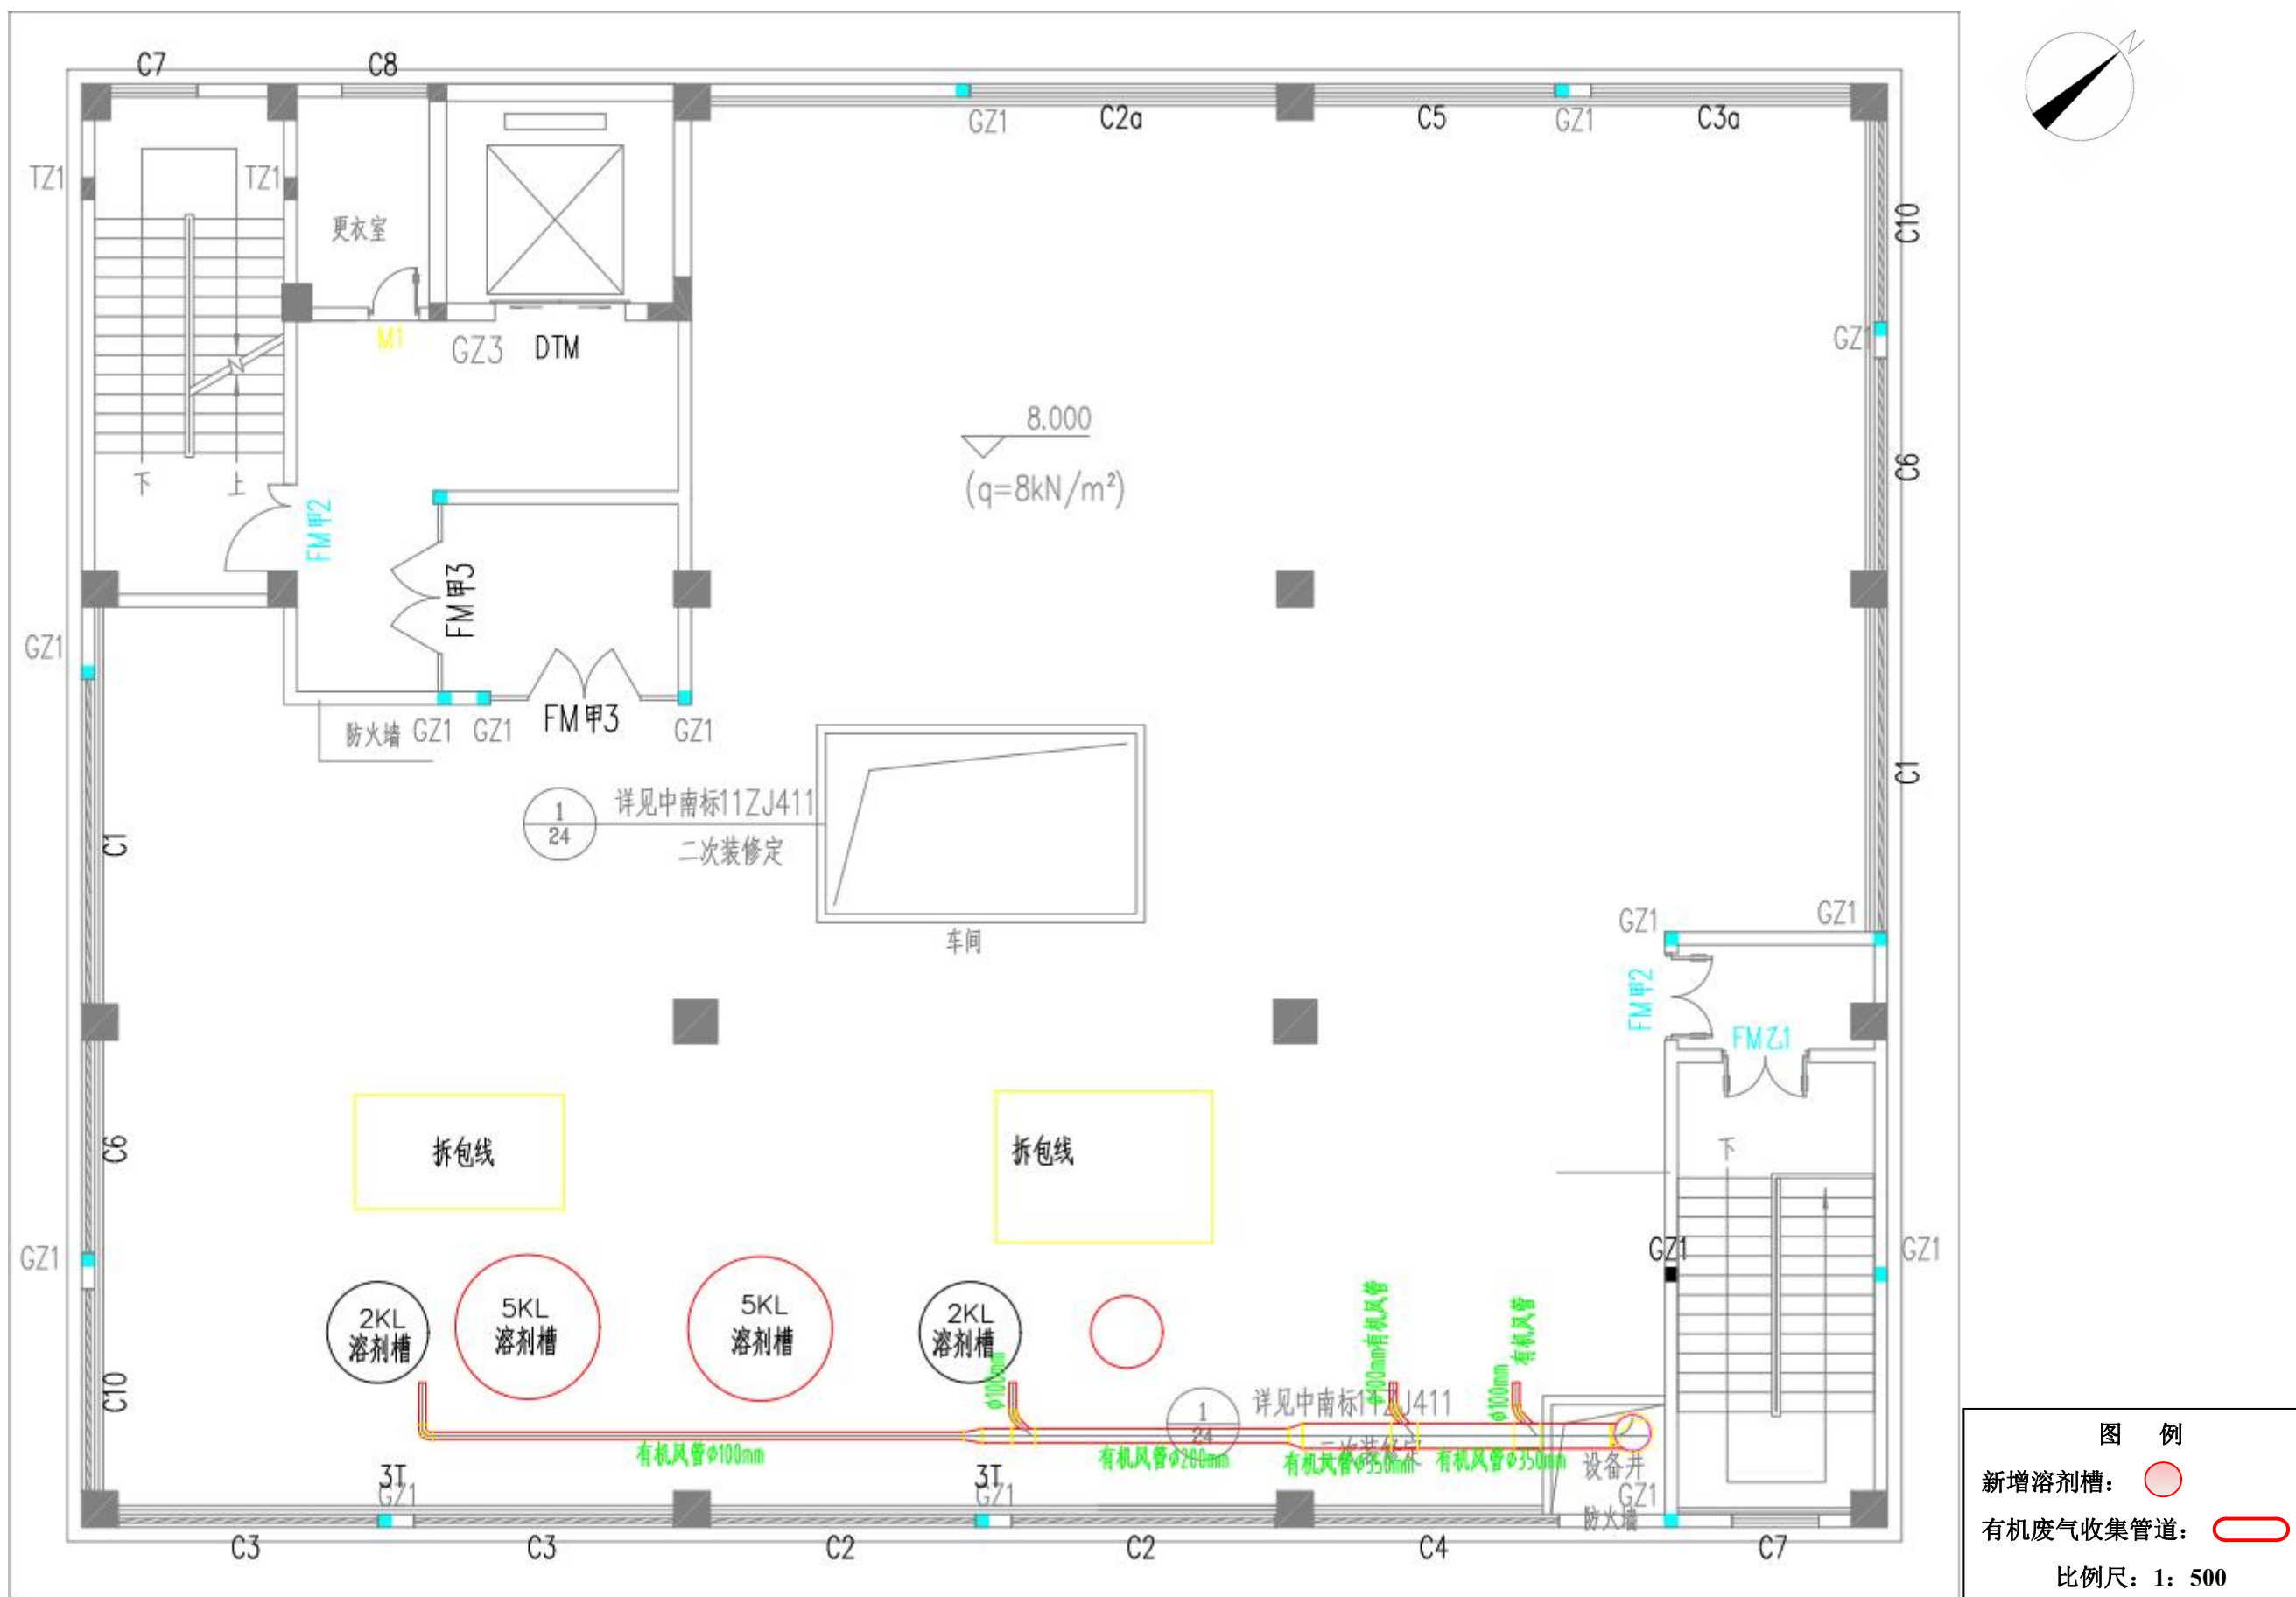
改扩建后，树脂生产线 3F 平面布置图
